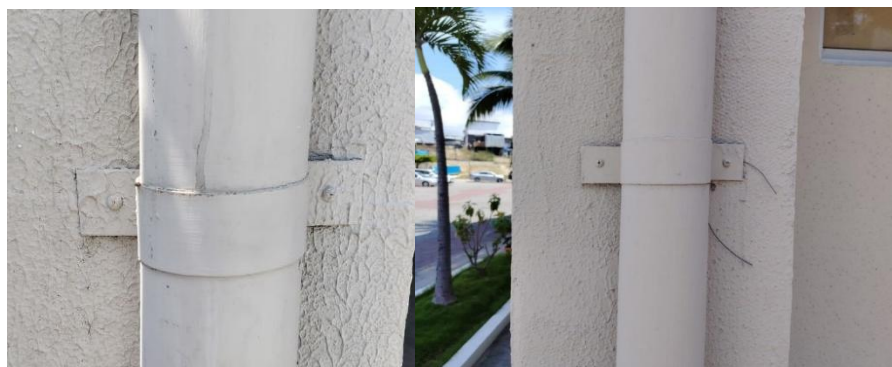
Columna A1 en la izquierda y columna G6 en la derecha, ambas perforadas en la planta baja.
